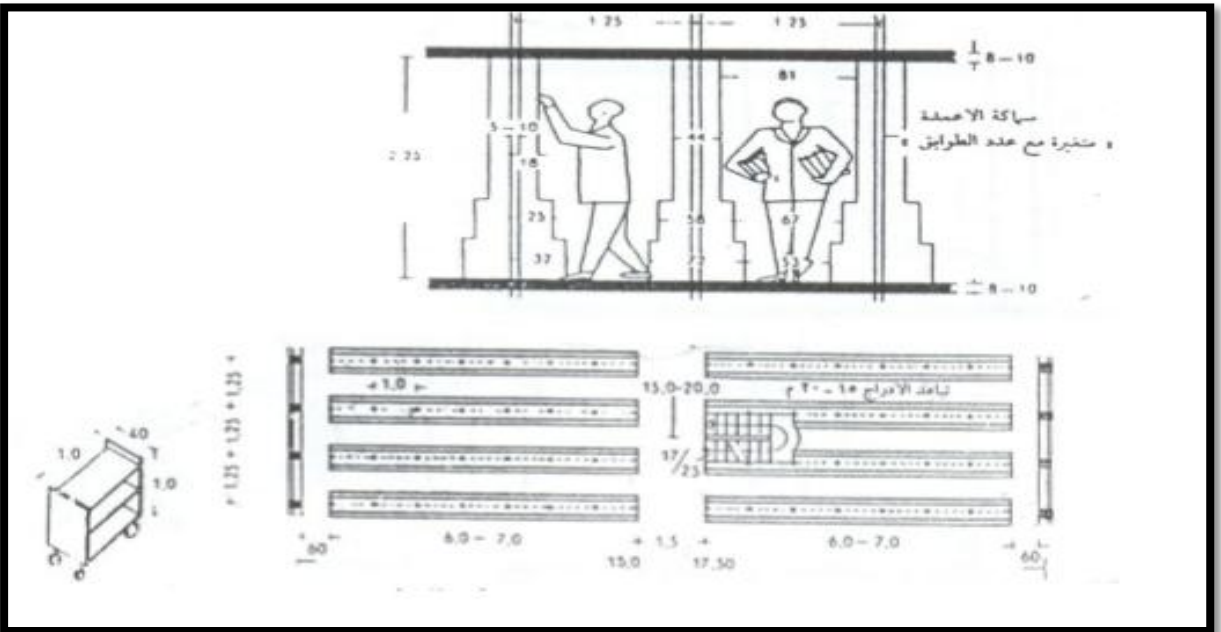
يوضح مسقط افقي لفرش صحيح لمكتبة.
